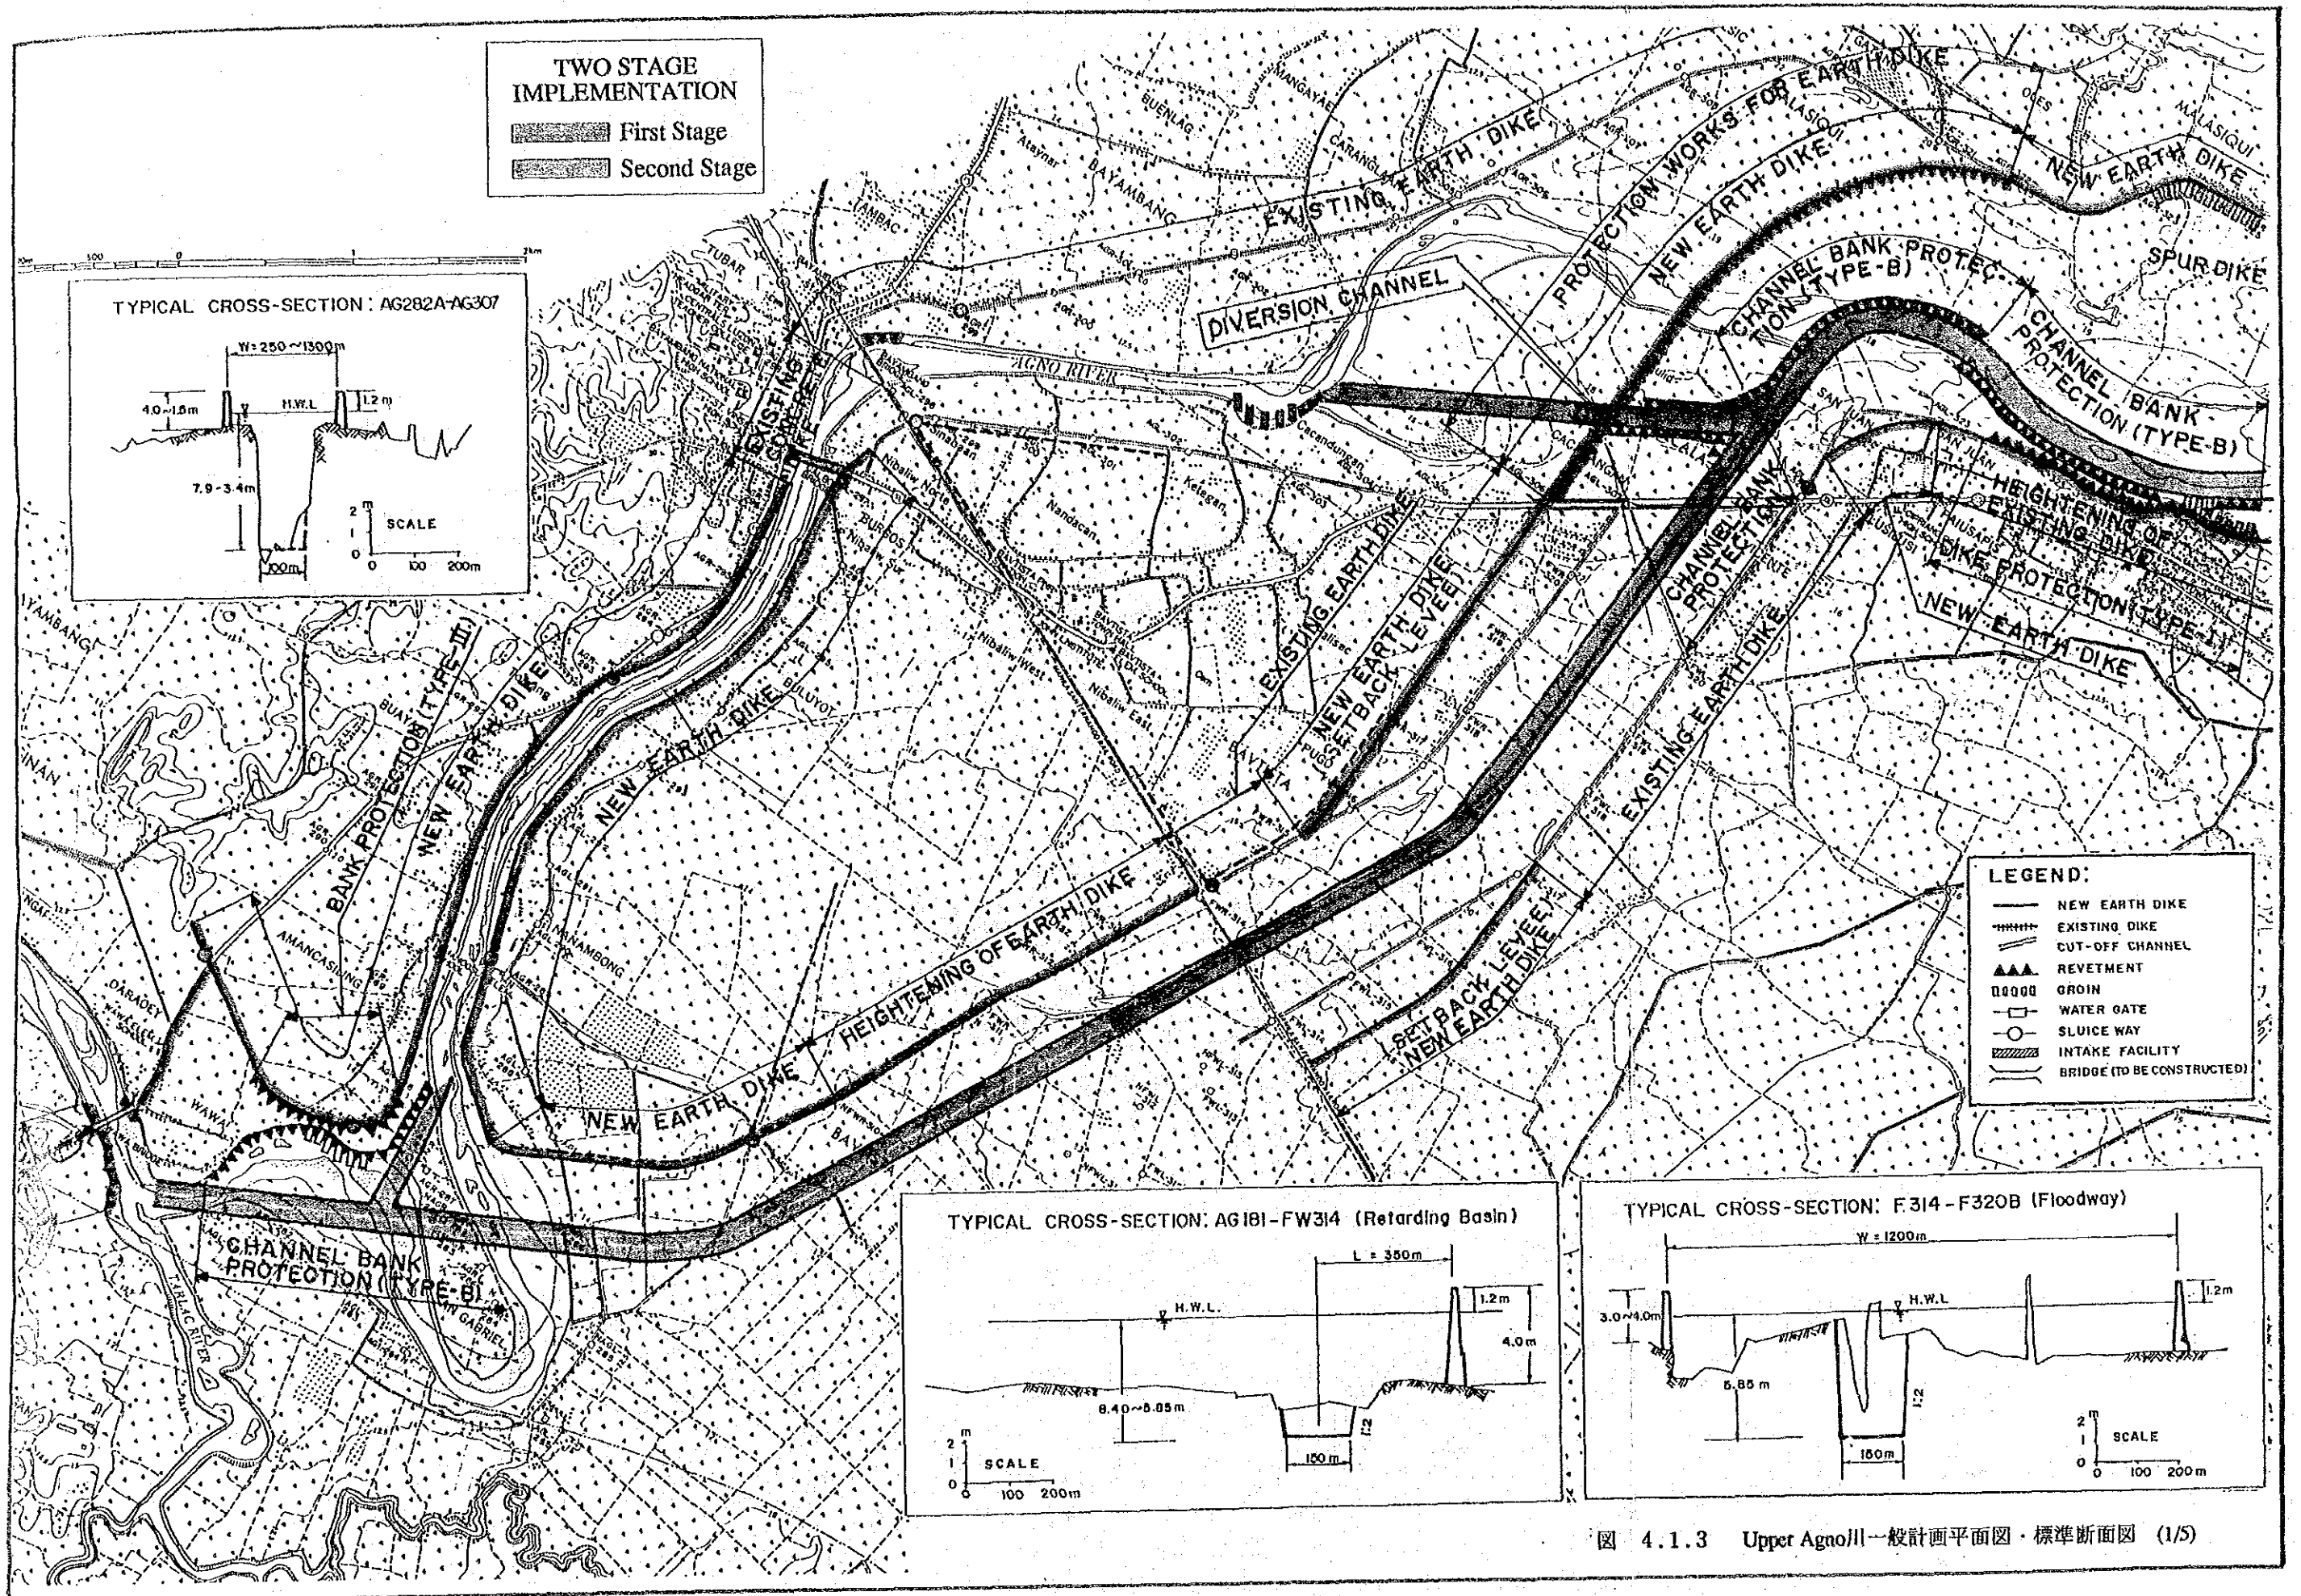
Upper Agno川一般計画平面図・標準断面図 (1/5)
